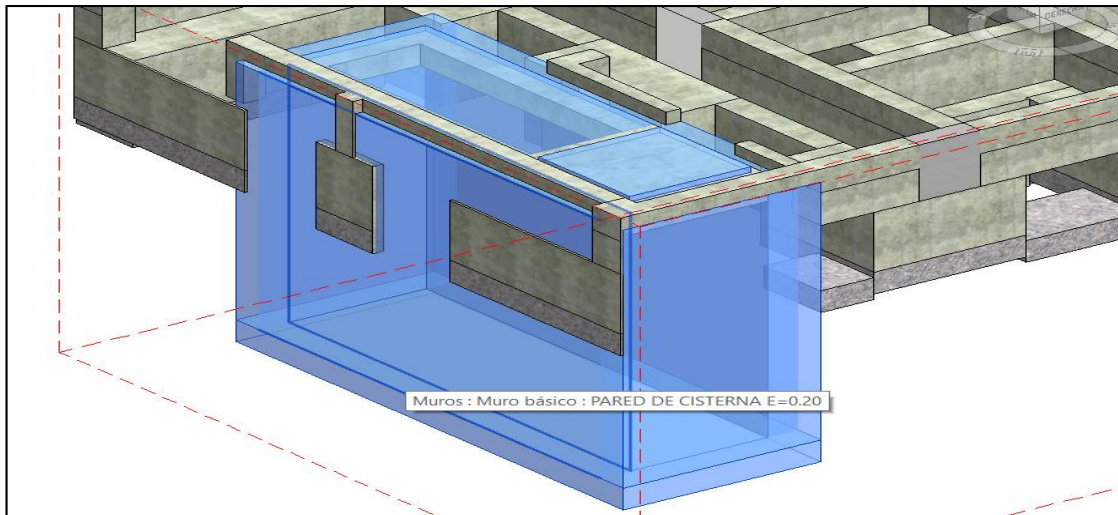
Vista 3D - Cisterna Subterránea en caja de sección en BIM
